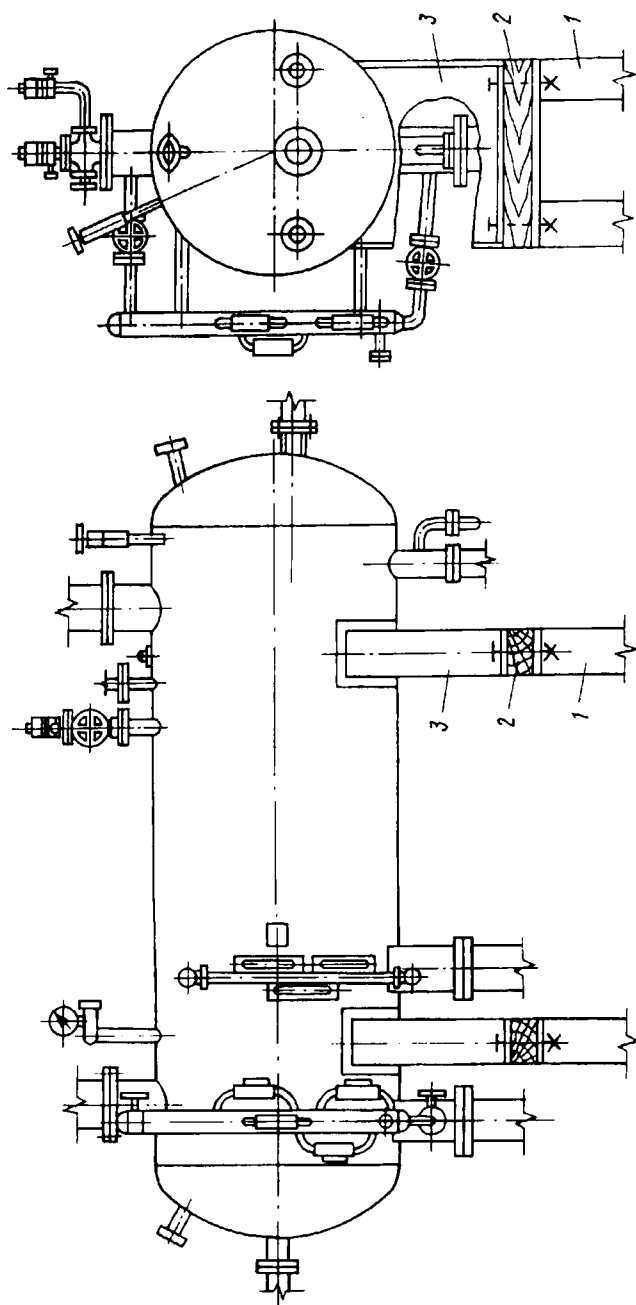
Размещение на фундаменте циркуляционного ресивера:
